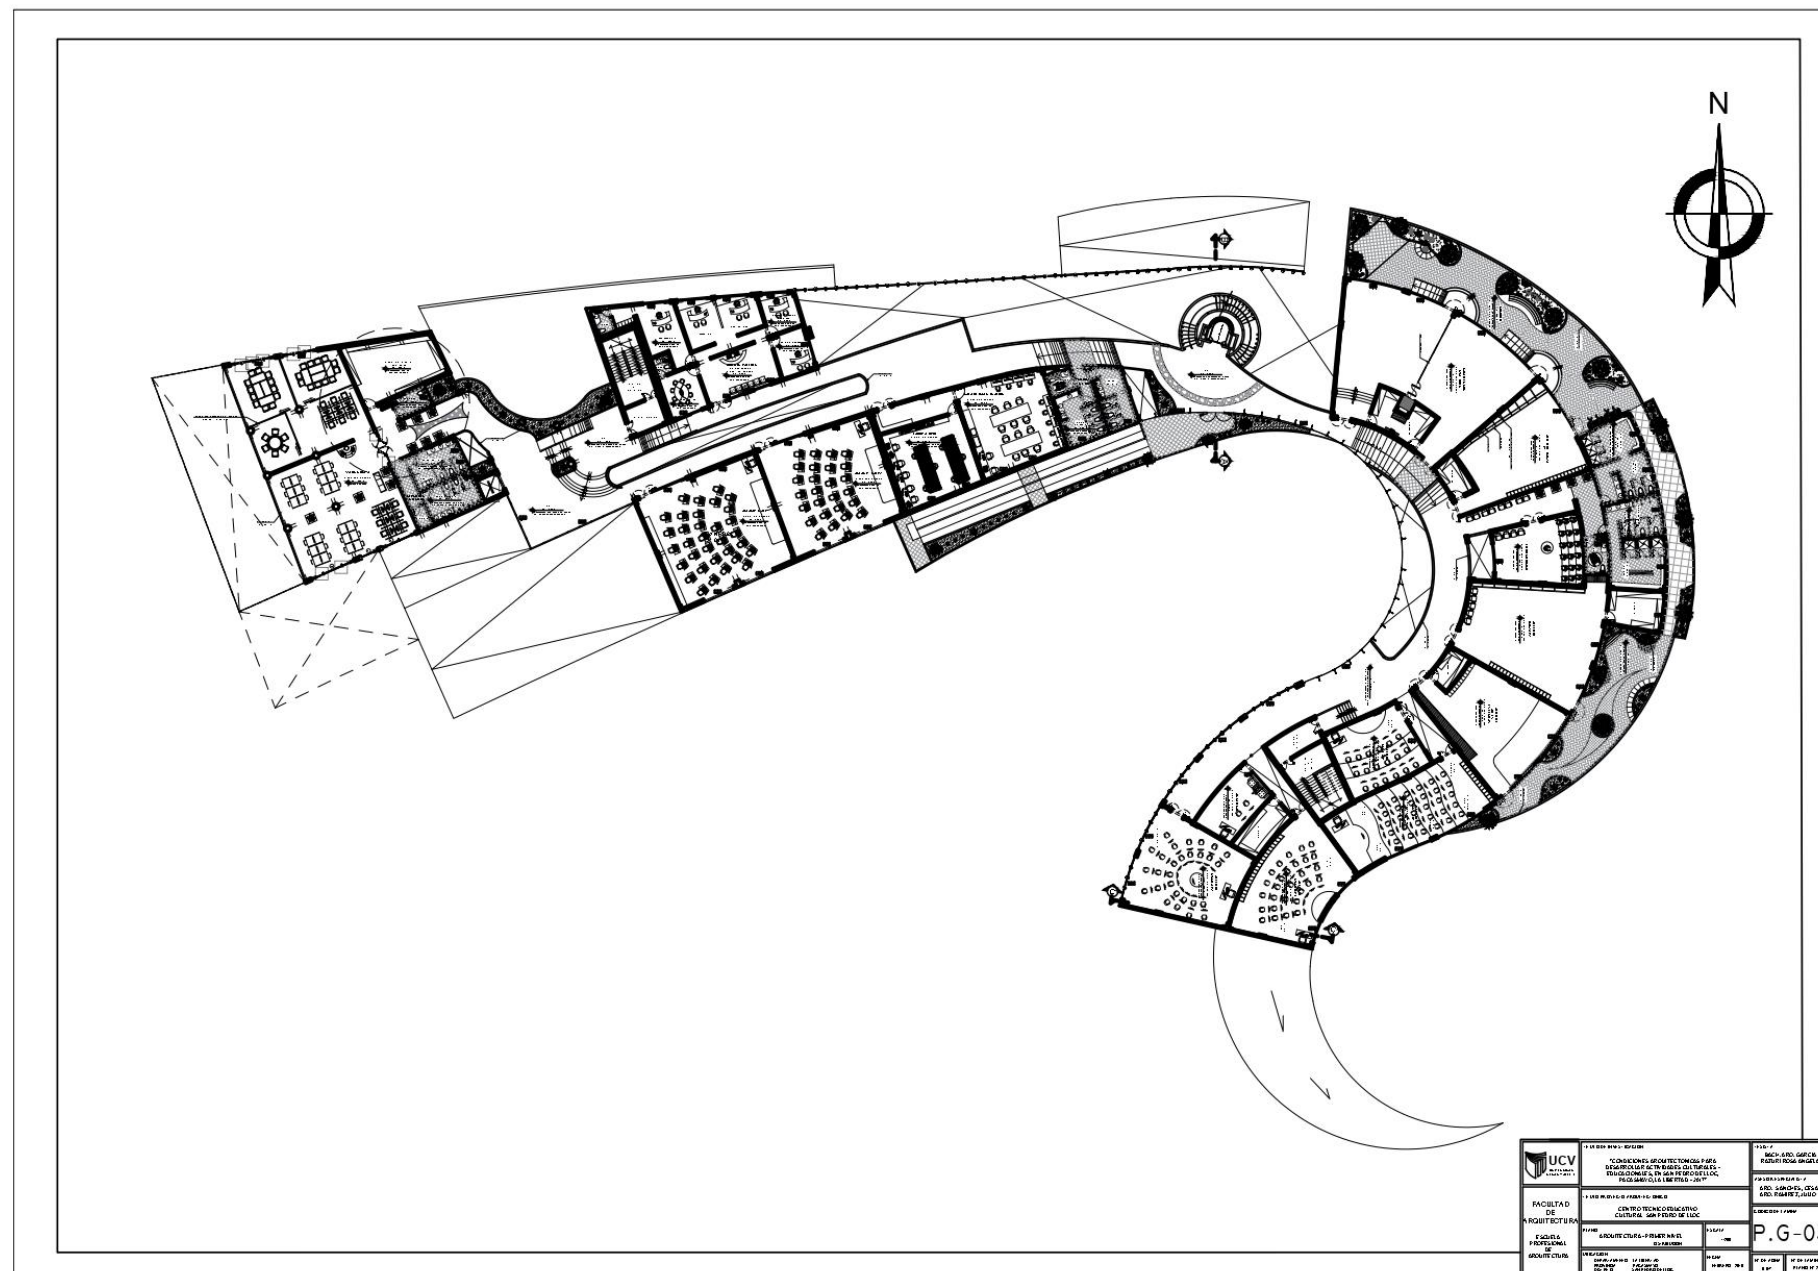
Plano de Distribución General 3er Nivel - Plano N° 24 - Lamina N°: P.G. - 03
